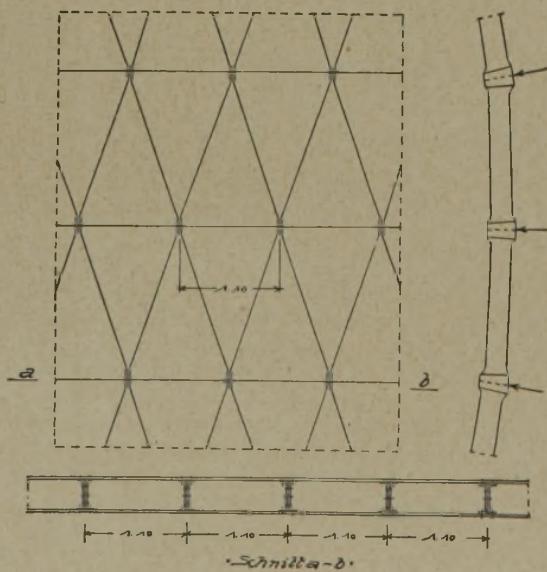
Schema des Lamellendaches u. Schnitt a-b.
